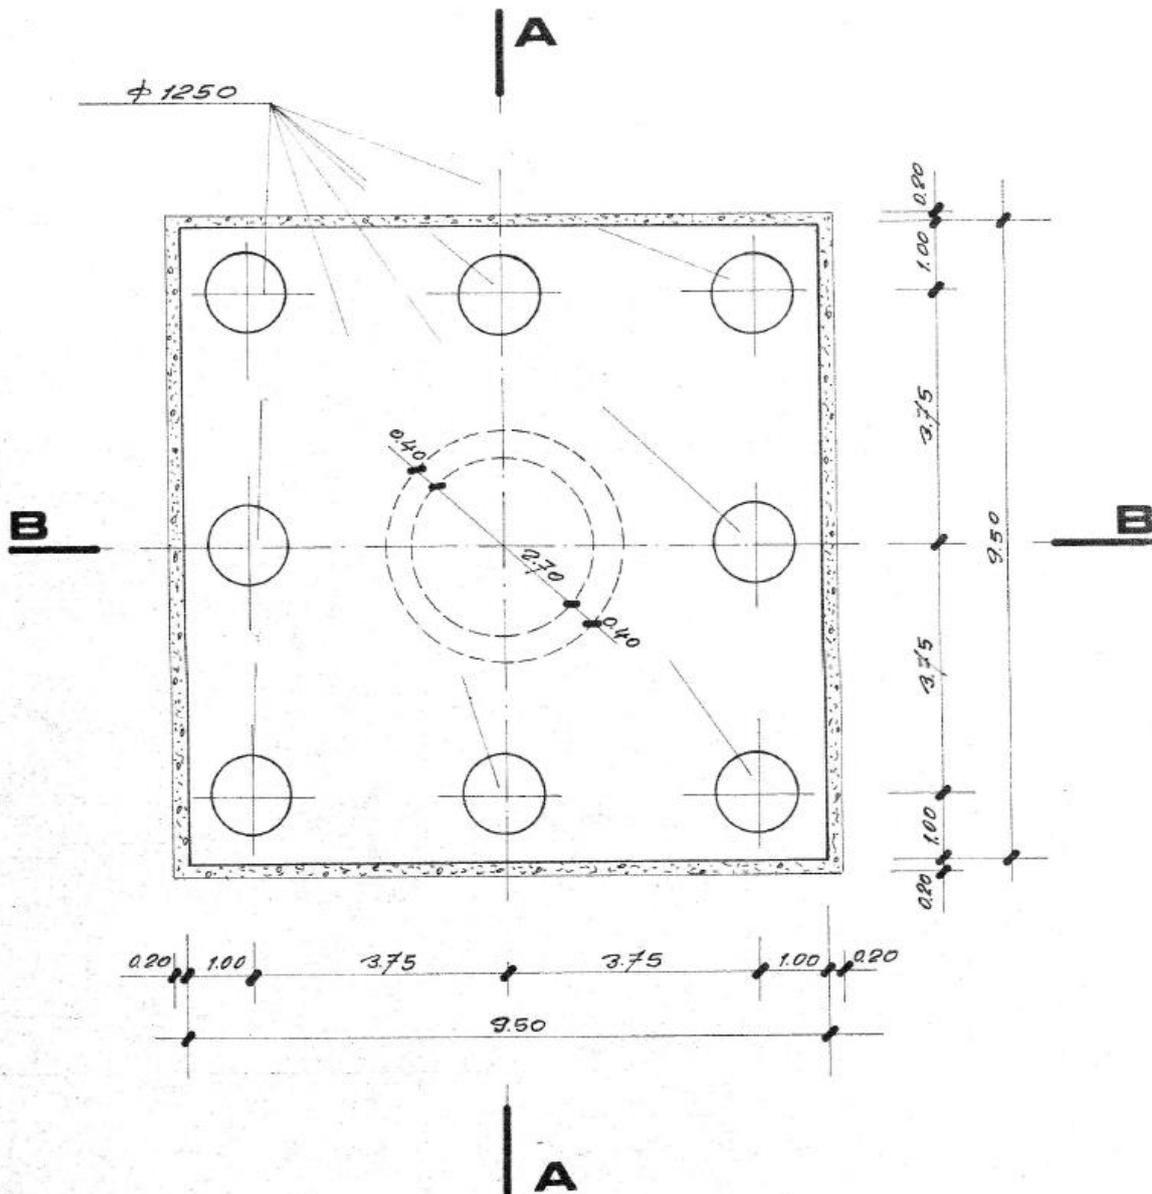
Impalcato a 3 travi in CAP – Pianta plinti ad 8 pali
